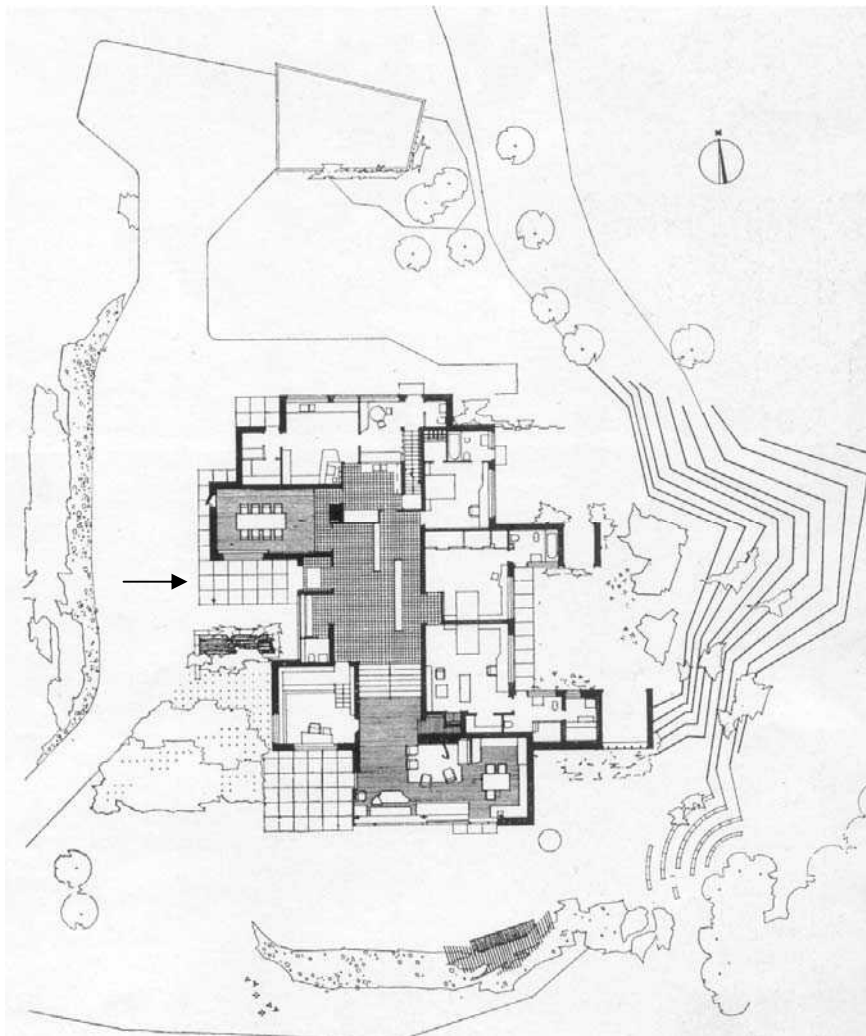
Planta pavimento térreo.A seta indica a entrada da galeria.
